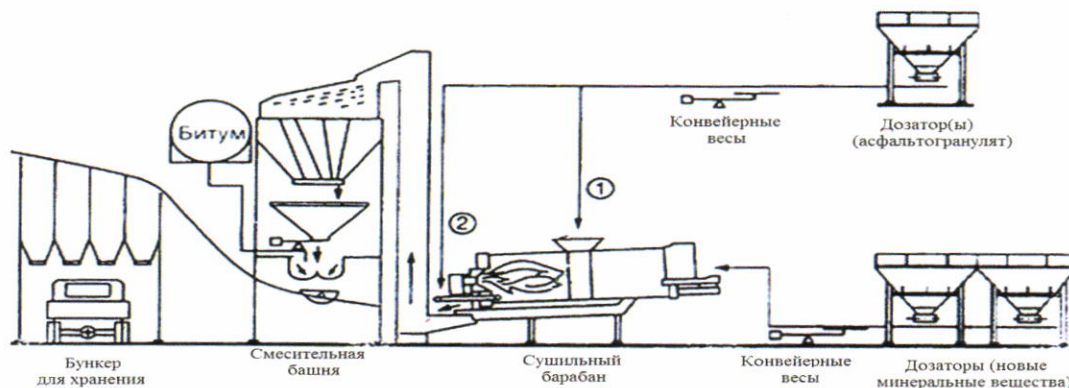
Смеситель периодического действия, нагревание вместе с минеральными материалами. Варианты добавления: 1 - по центру в специально оборудованный сушильный барабан, 2 - через швырковый транспортер с торцевой стороны, где находится горелка (подача через швырковый транспортер)
